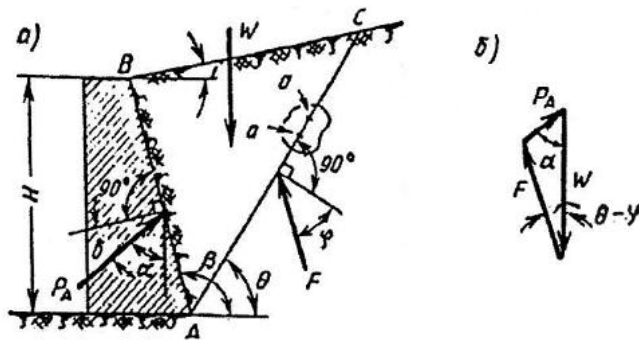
Расчетная схема к определению активного давления грунта на стенку: а) разрез по стенке и засыпке; б) треугольник сил
